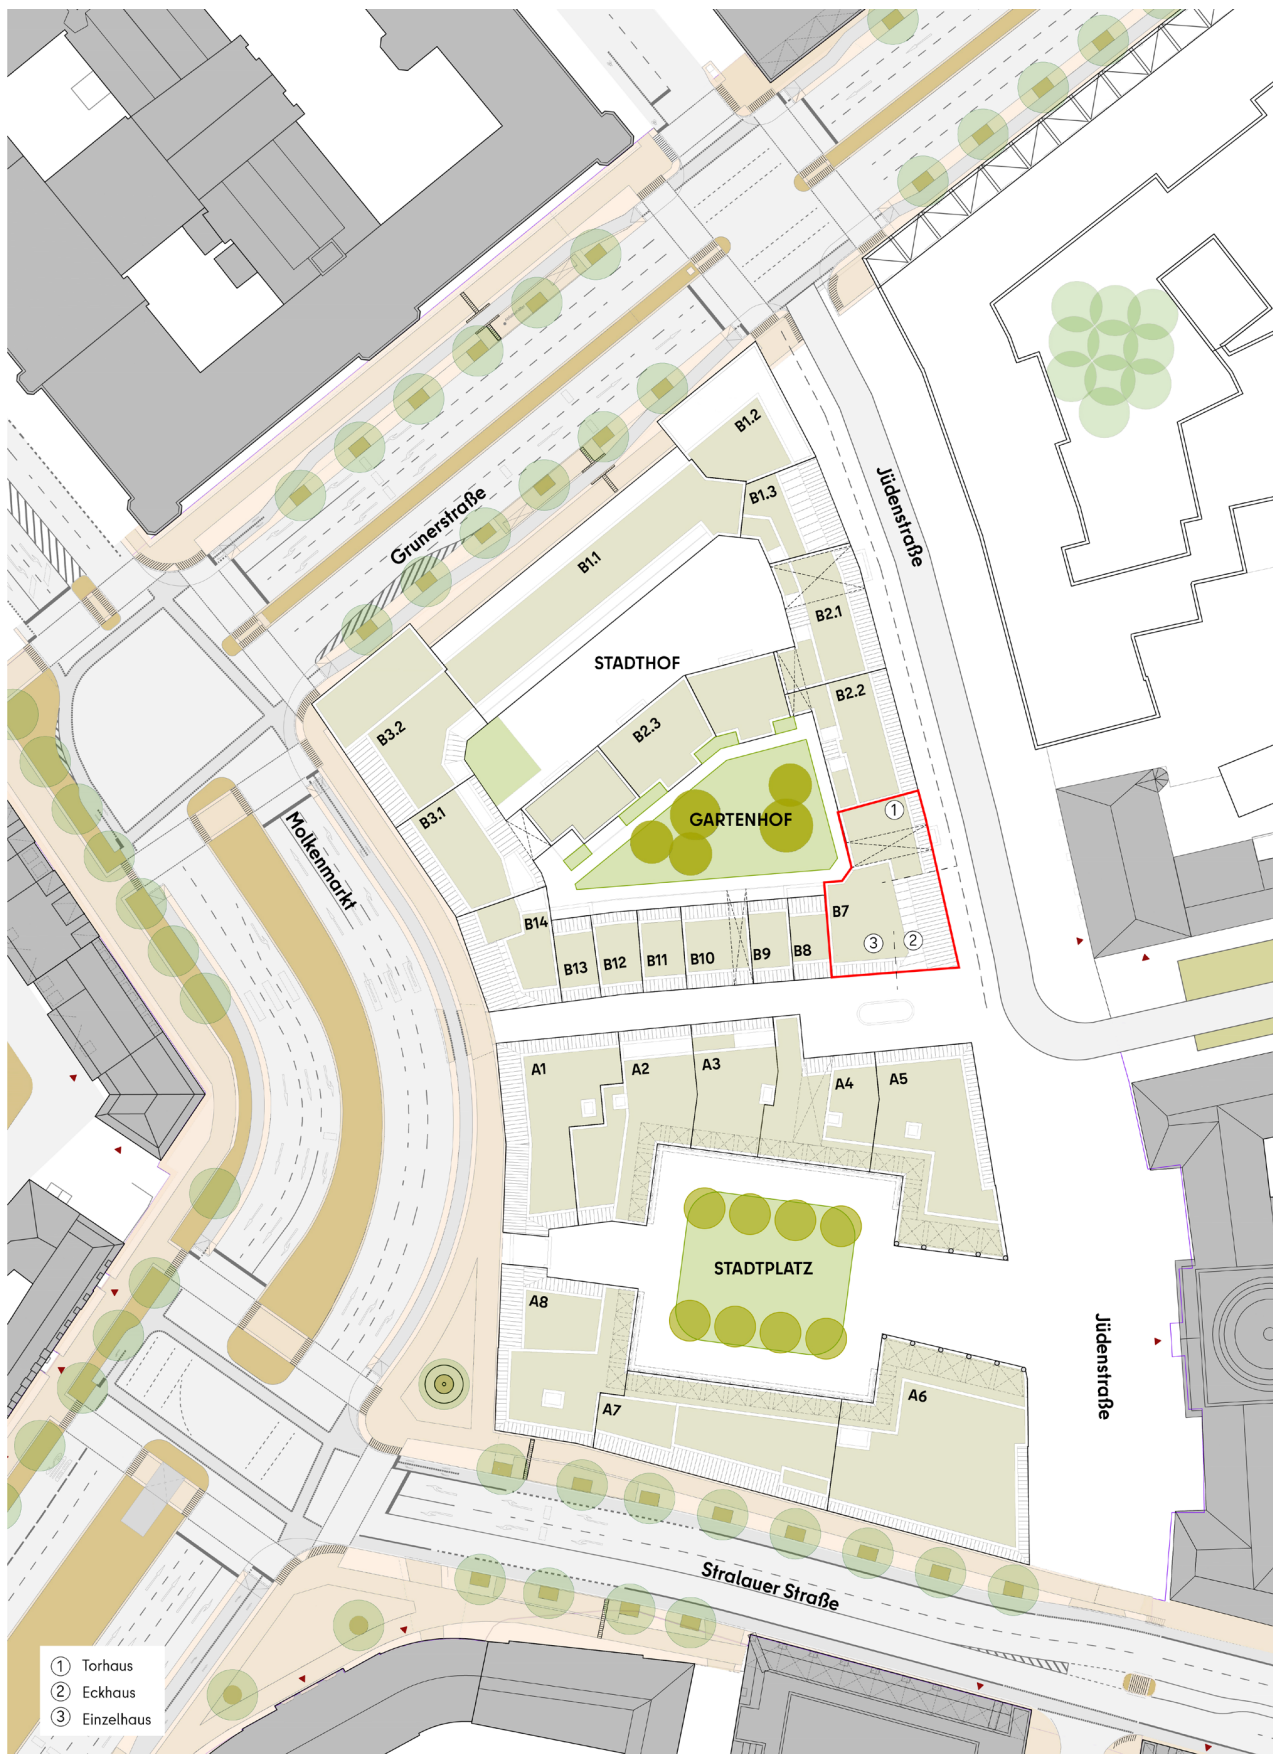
Dachaufsicht Block A und B mit Lage Haus B 7
